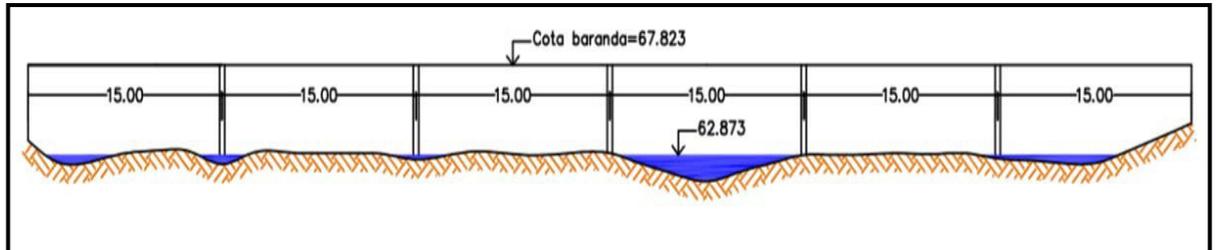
Sección transversal del puente existente s/ A° de Las Mostazas
